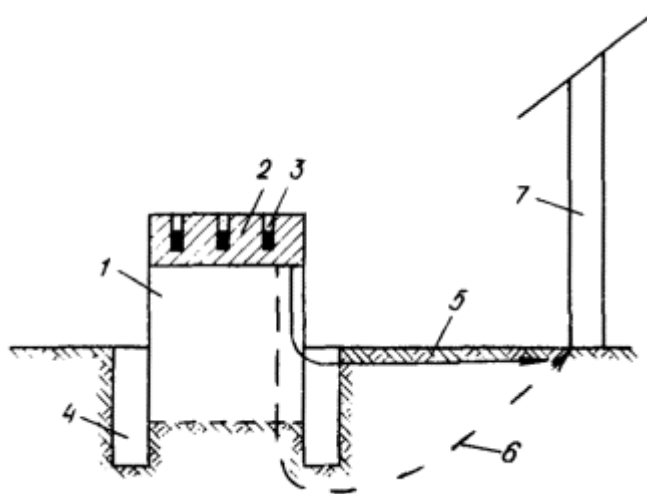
Схема окопки разрушаемого взрывом фундамента:
